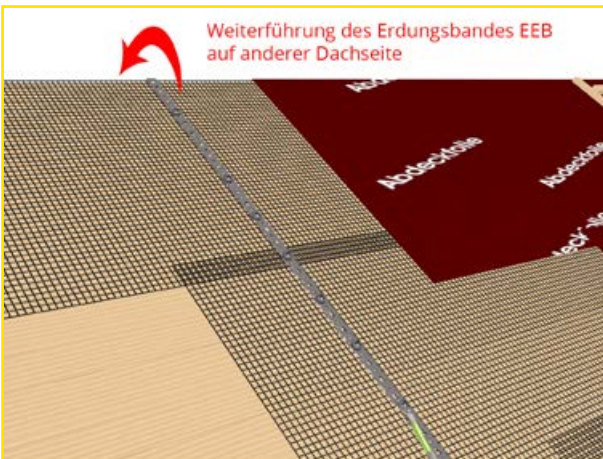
Erdung der Dachfläche (EEB+RKS16)
